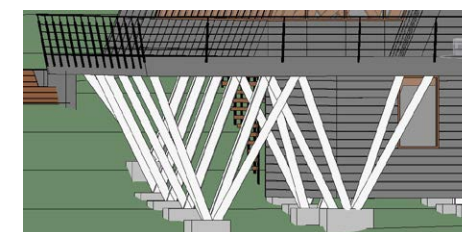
Struttura in acciaio: profili IPE e a sezione circolare
